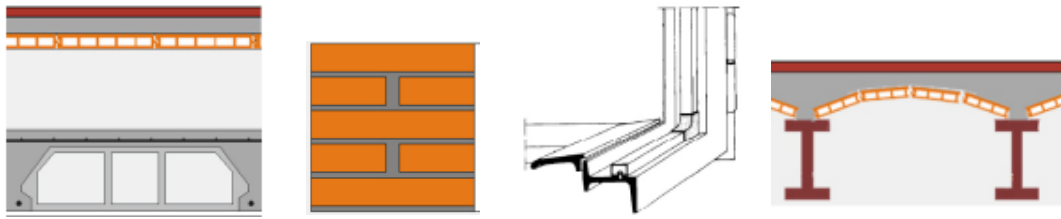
Detalles constructivos Cubierta, Fachada, Carpintería, Forjado. Fuente TABULA [108]
